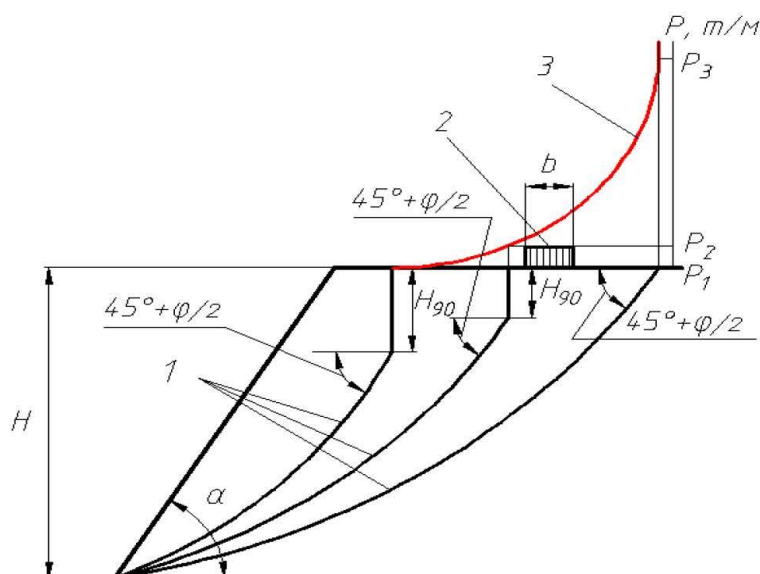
Схема к расчету устойчивости откосов с учетом допустимых статических нагрузок: 1 – расчетные поверхности скольжения; 2 – нагрузка от горного оборудования; 3 – эпюра нагрузки
